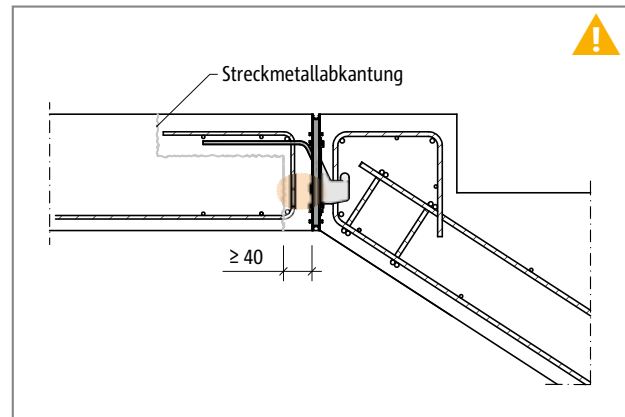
Schöck Tronsole® Typ T: Einbau in Verbindung mit Arbeitsfugen am Deckenrand, Druckfuge deckenseitig
